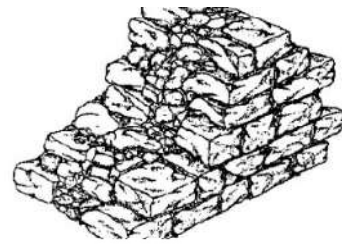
Ejemplo de mampostería a calicanto con el núcleo incierto Fuente: Manual de detección de la vulnerabilidad sísmica de los edificios en mampostería p. 20
